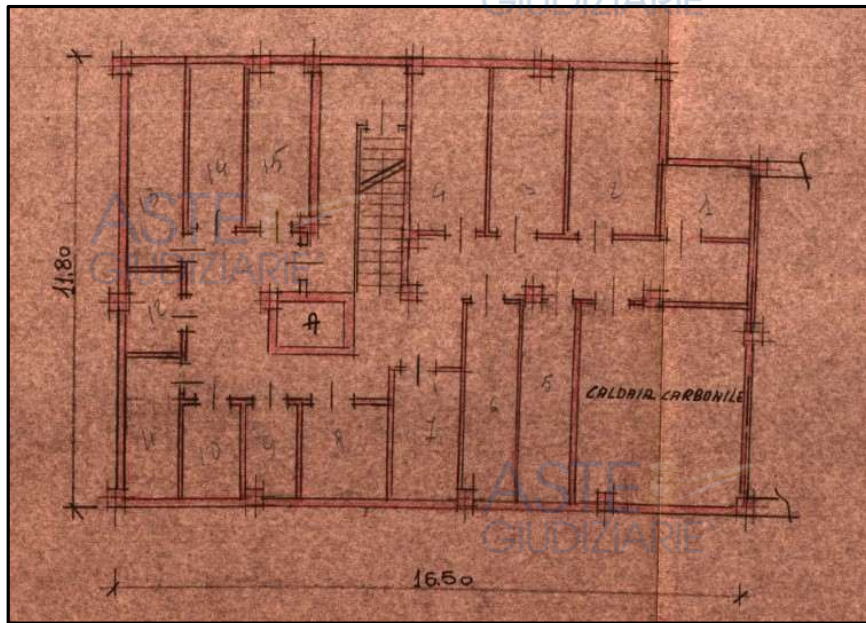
Estratto planimetria piano progetto cantine Licenza edilizia prot. n. prot. 1957 I 21011
